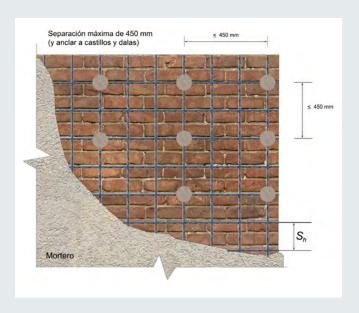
Detalles para la colocación de malla de alambre soldado sobre muros de mampostería. Fuente: elaboración propia con base en NTC-Mampostería (2017).
